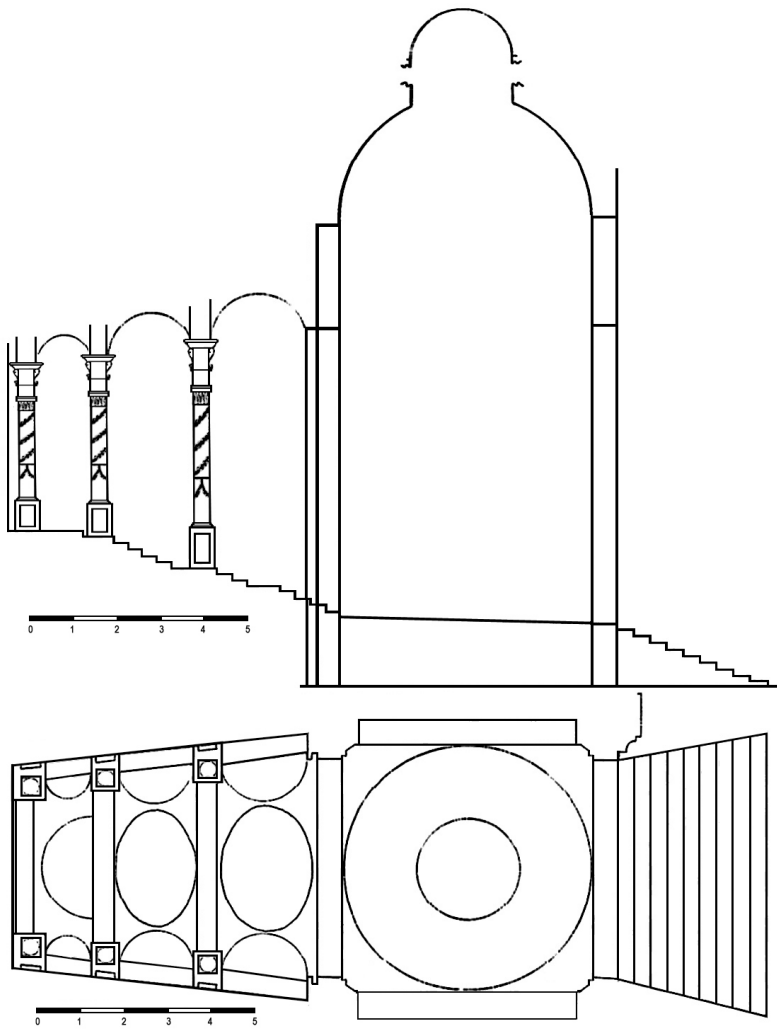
Monumento de La Seo de Zaragoza. Alzado y planta
